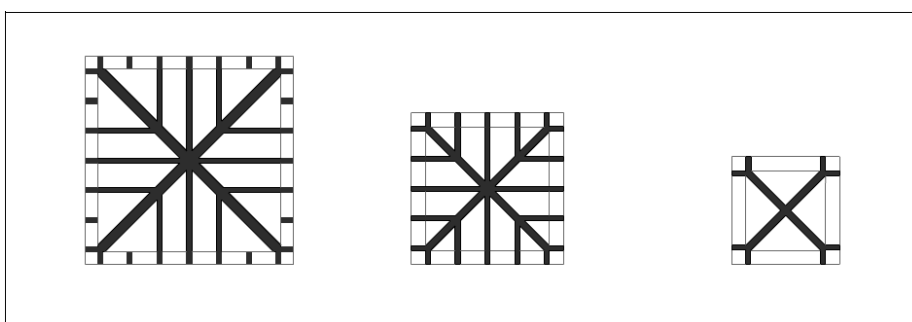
Planta típica de torre de cuatro lados diagonal. Elaboración propia (Roaf, 1988)
